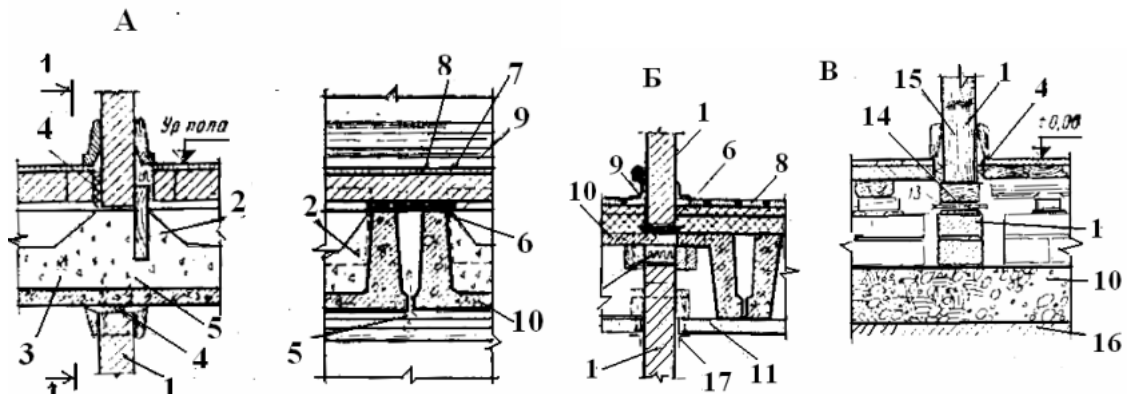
Прийоми герметизації швів навколо перегородок: А – обпирання перегородки при встановленні її поперек ребер перекриття; Б – примикання перегородки при підвісії стелі; В – обпирання перегородки при підлозі по лагах; 1-панельна перегородка; 2-дошка; 3-відсіпка шлаком; 4-конопатка; 5-йоржи в швах панелей; 6-упруга прокладка; 7-гіпсобе-тонна плита (основа підлоги); 8-покриття підлоги; 9-плінтус; 10-плити перекриття; 11-піввісна стеля; 14-антисептирований брусок; 15-штукатурка; 16-трамбований ґрунт; 17-карниз по шву
